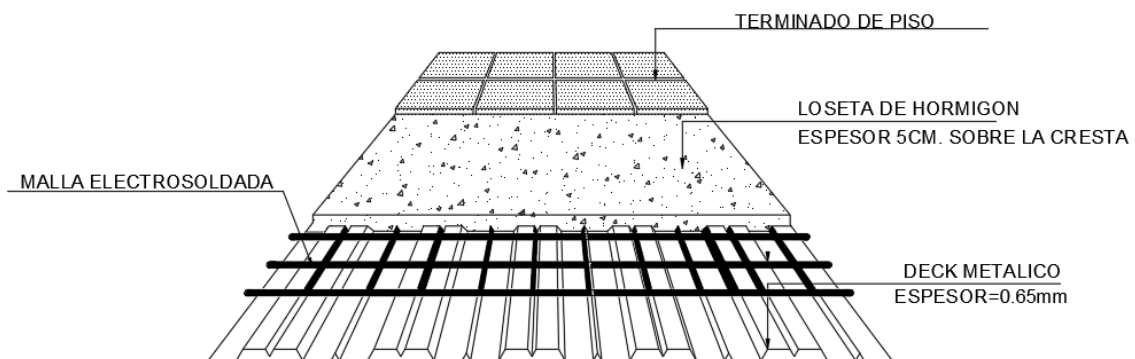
Representación de cargas muertas sobre losa tipo deck
